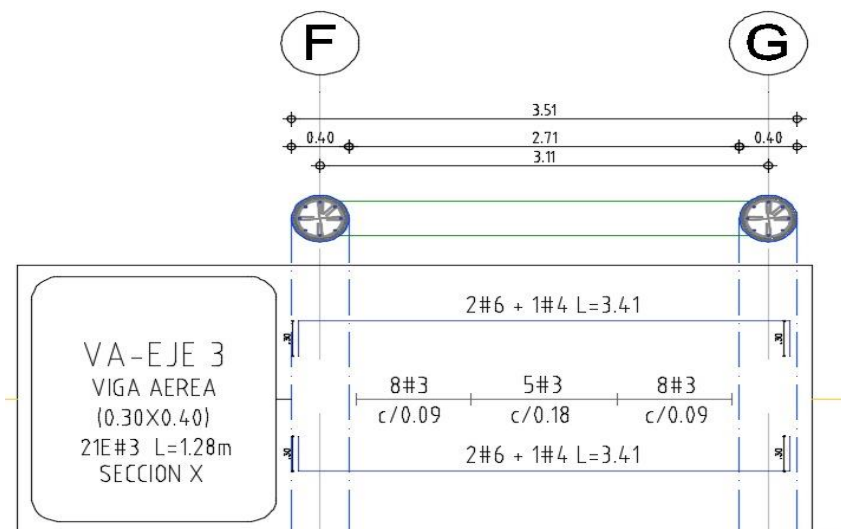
Presentación de distribución refuerzo transversal en la viga.
